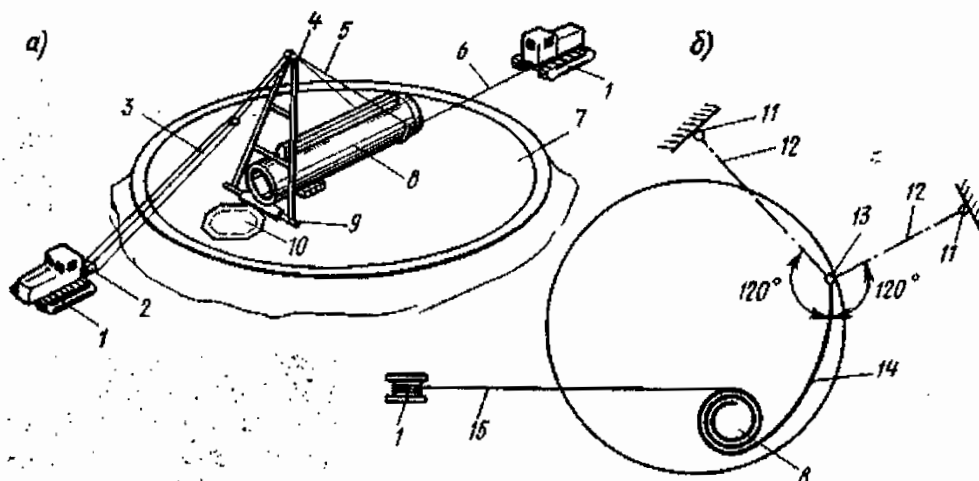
Схема монтажа стенки резервуара из рулонной заготовки:
